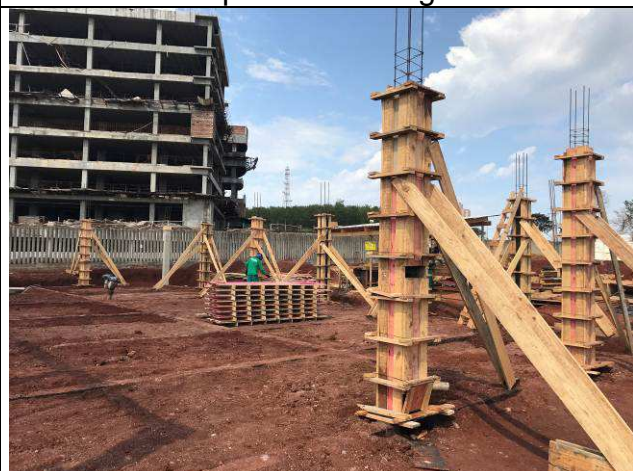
C: Formas e armaduras dos pilares do prédio do arquivo.
